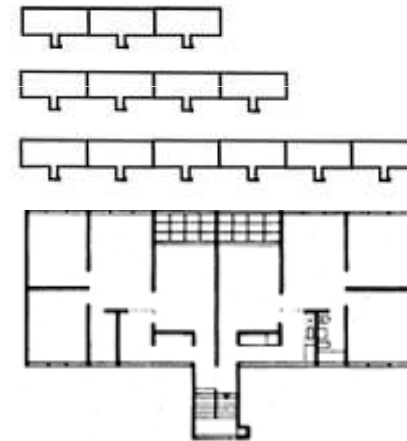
Planta baixa dos blocos. Fonte: "Análise Tipológica da Produção de Habitação Econômica no Brasil (1930-1964)"
